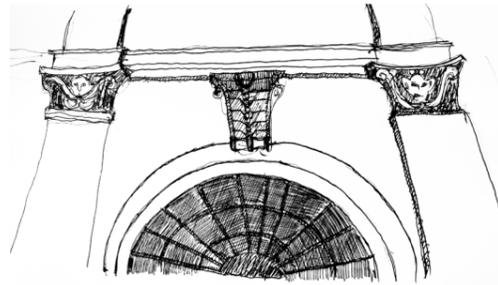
Detalle de ornamentación pilastras de puerta. Fuente: Fot. autores (2014).
